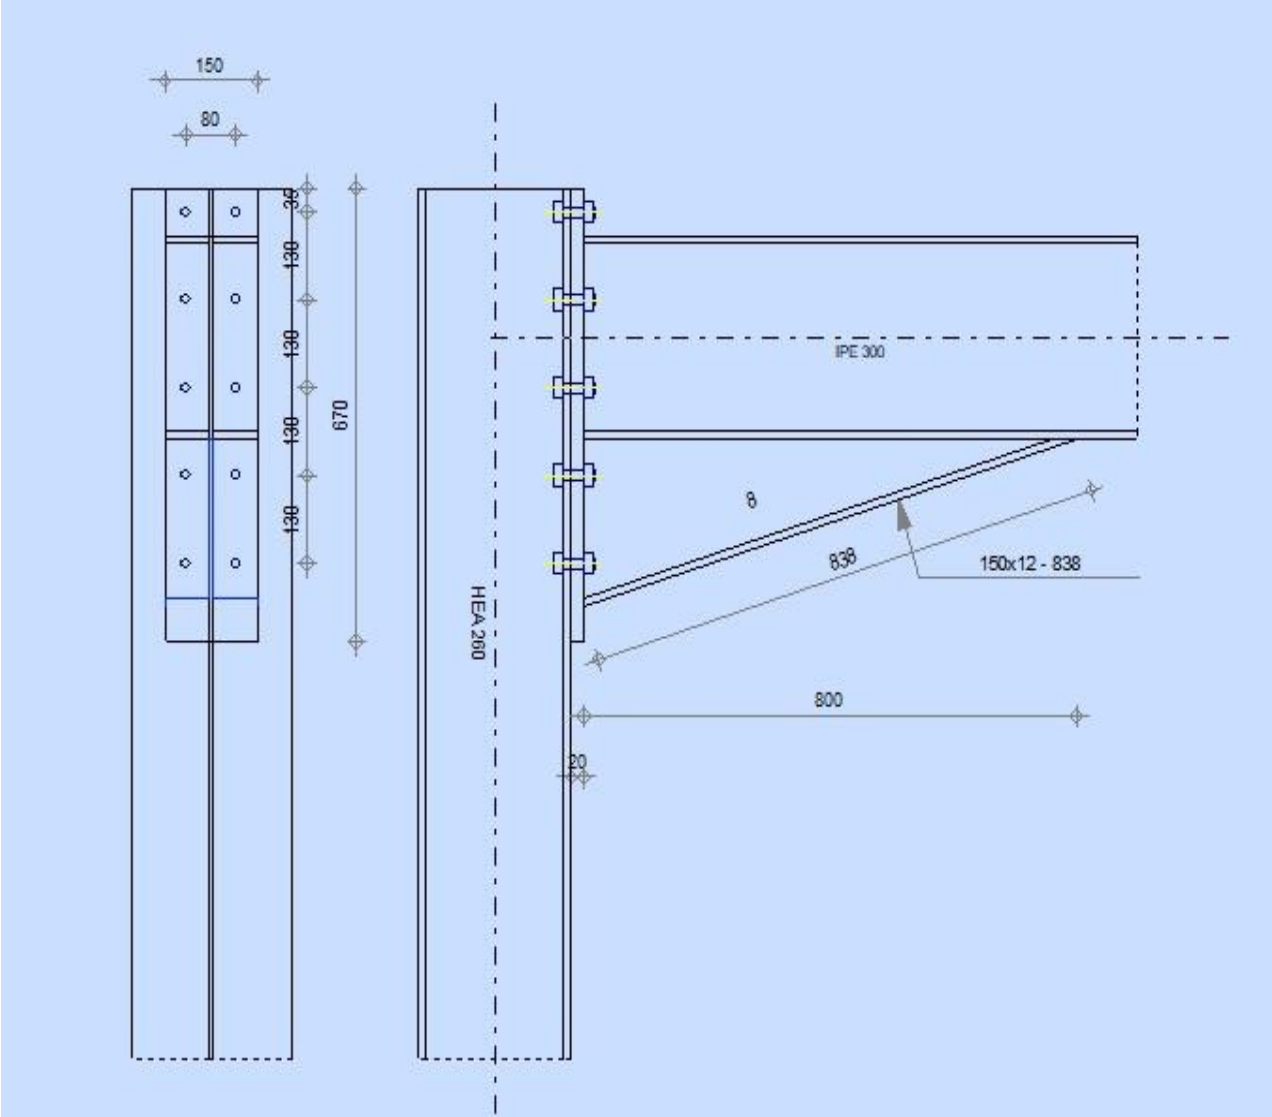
Schéma d'assemblage poteau-poutre principale
